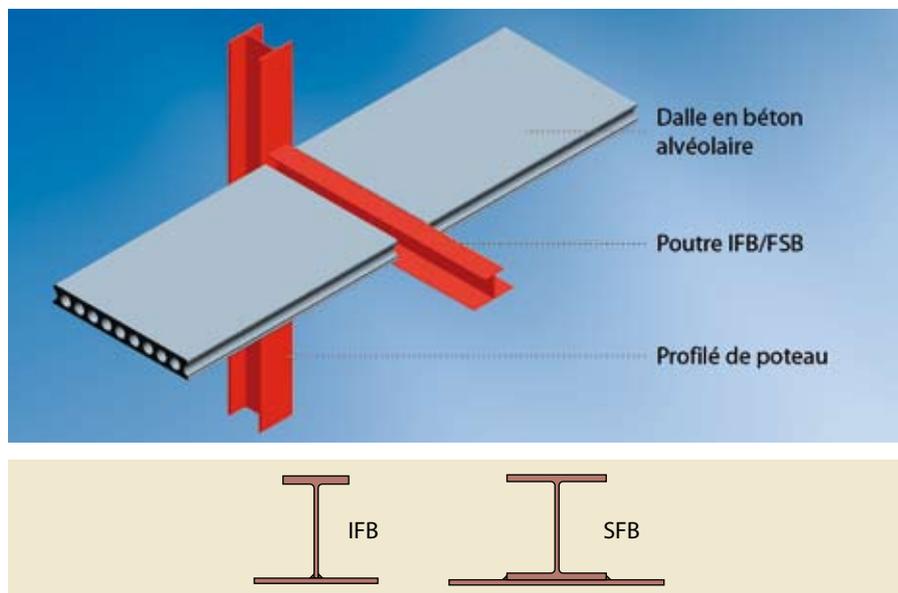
Plancher intégré typique réalisé au moyen d'une dalle en béton préfabriqué
